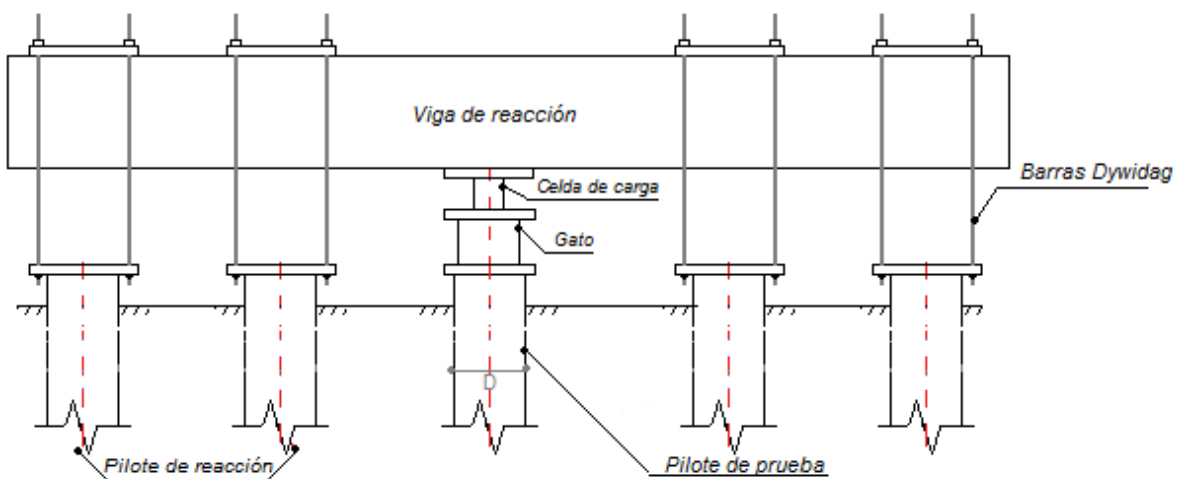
Sistema de reacción con 4 pilotes en línea, Ingeniería de cimentaciones profundas, SMIG, 2017
